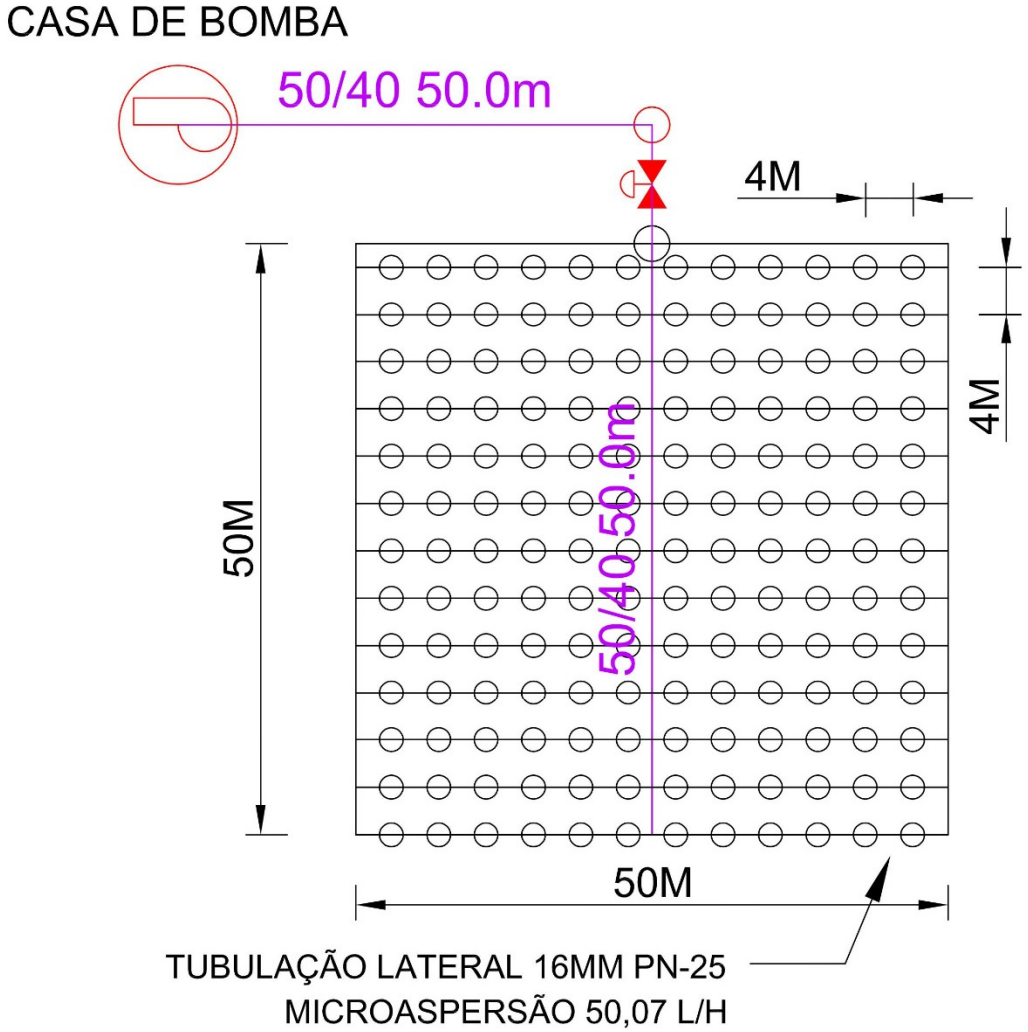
B – Detalhamento do projeto 3 (layout gerado pelo IrrigaCAD).
